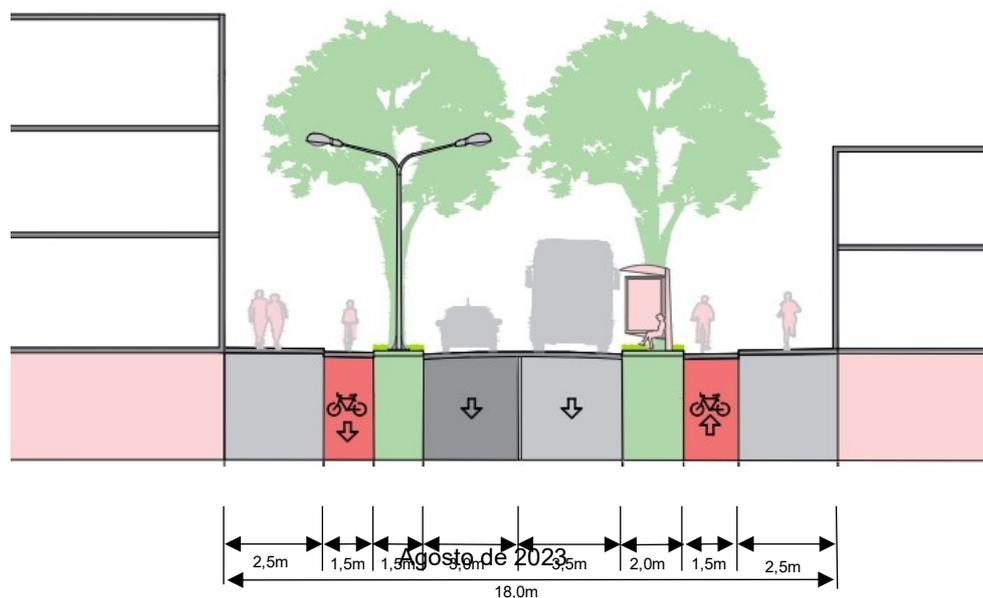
Faixa não edificante do binário Av. Presidente Costa e Silva e R. Walt Disney
